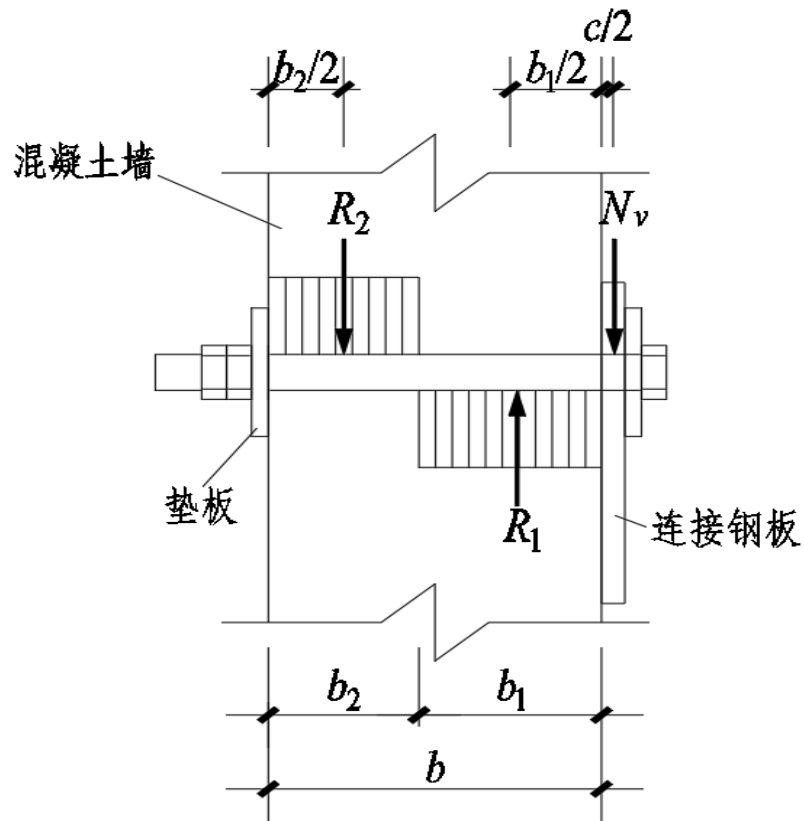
穿墙螺栓孔处混凝土受压示意图
